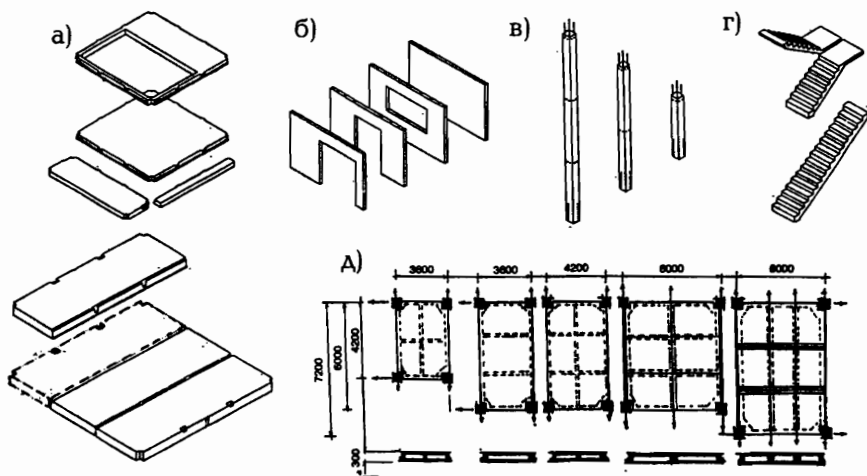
Примерная номенклатура сборных элементов, используемых для возведения жилых зданий: а – плит перекрытий, бортовых и консольных элементов; б – стенок жесткости; в – колонн различной этажности; г – лестничных маршей; д – конструктивное решение плит перекрытий в зависимости от размеров ячейки
